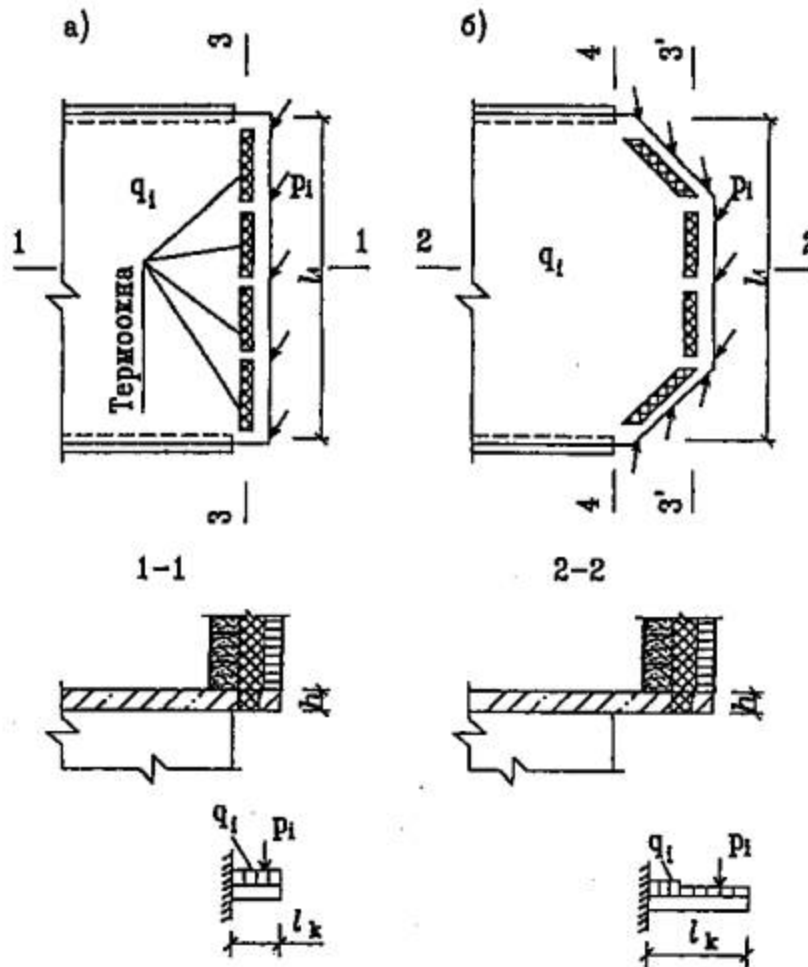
Схемы консольных участков плит перекрытий при несущих наружных стенах:
